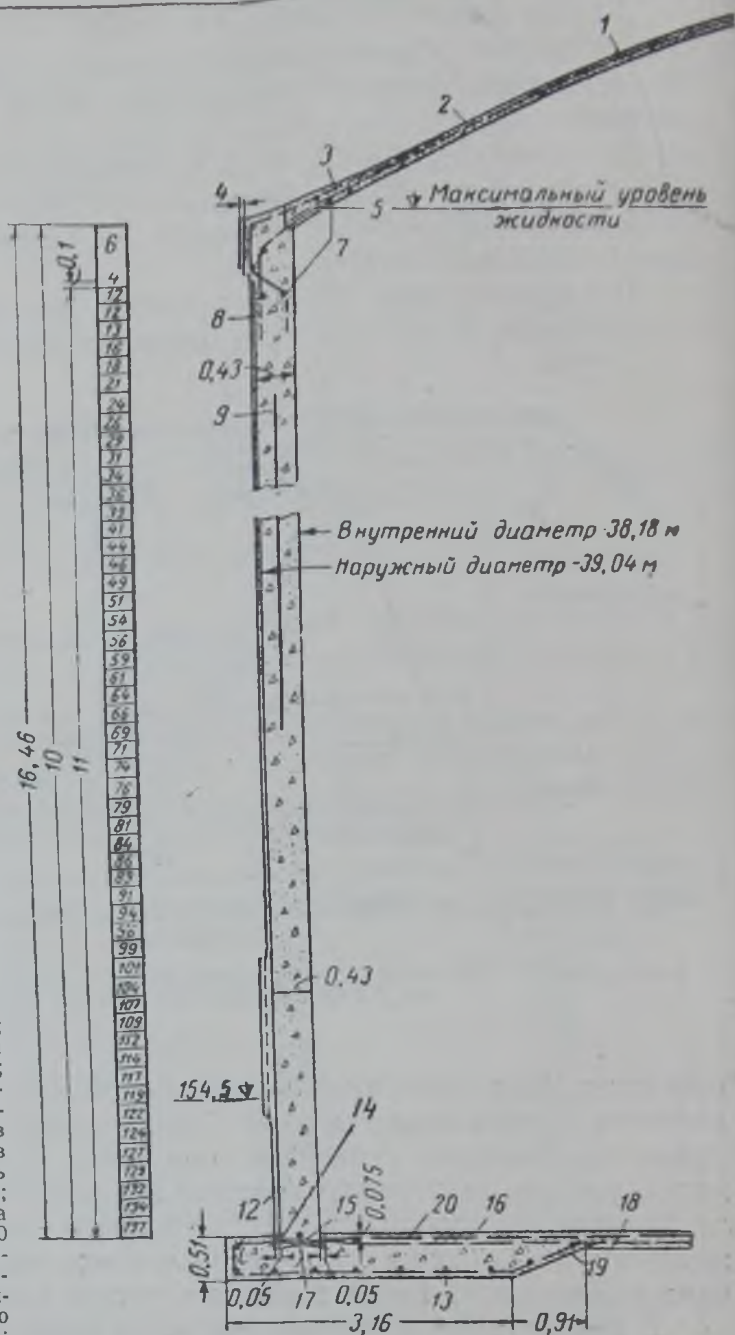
Вертикальный разрез стены напряженного железобетонного резервуара (по материалам Preload Construction Corp.)
